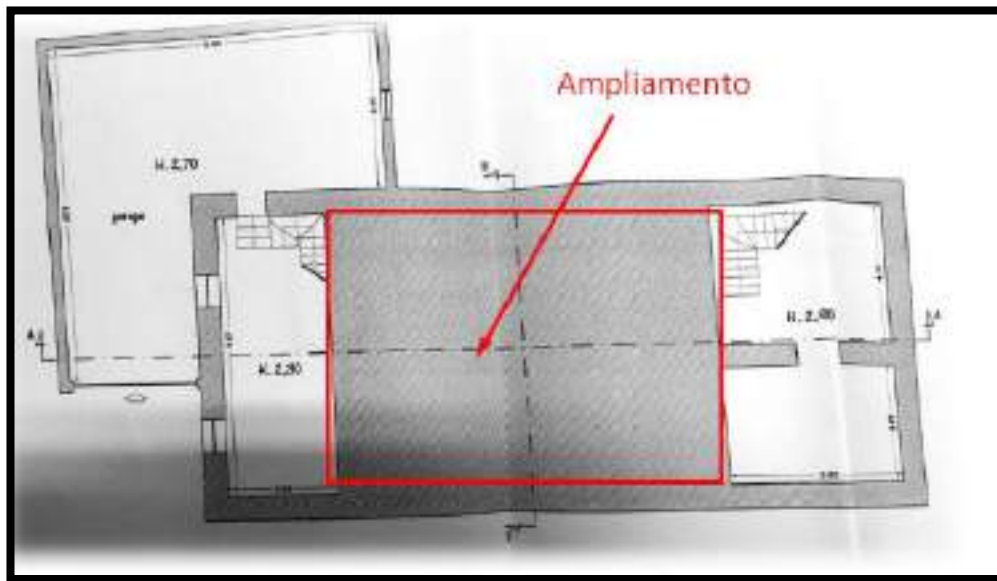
Pianta piano interrato allegata alle pratiche di condono
